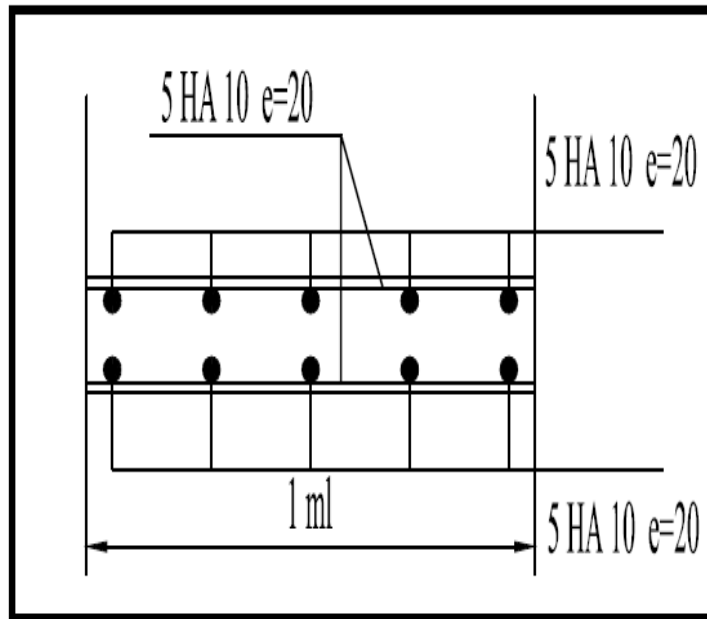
Schéma de ferrailage de la dalle La dalle de l'ascenseur.
